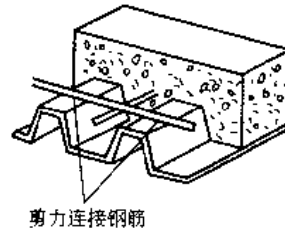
无痕开口式压型钢板上翼焊剪力钢筋
